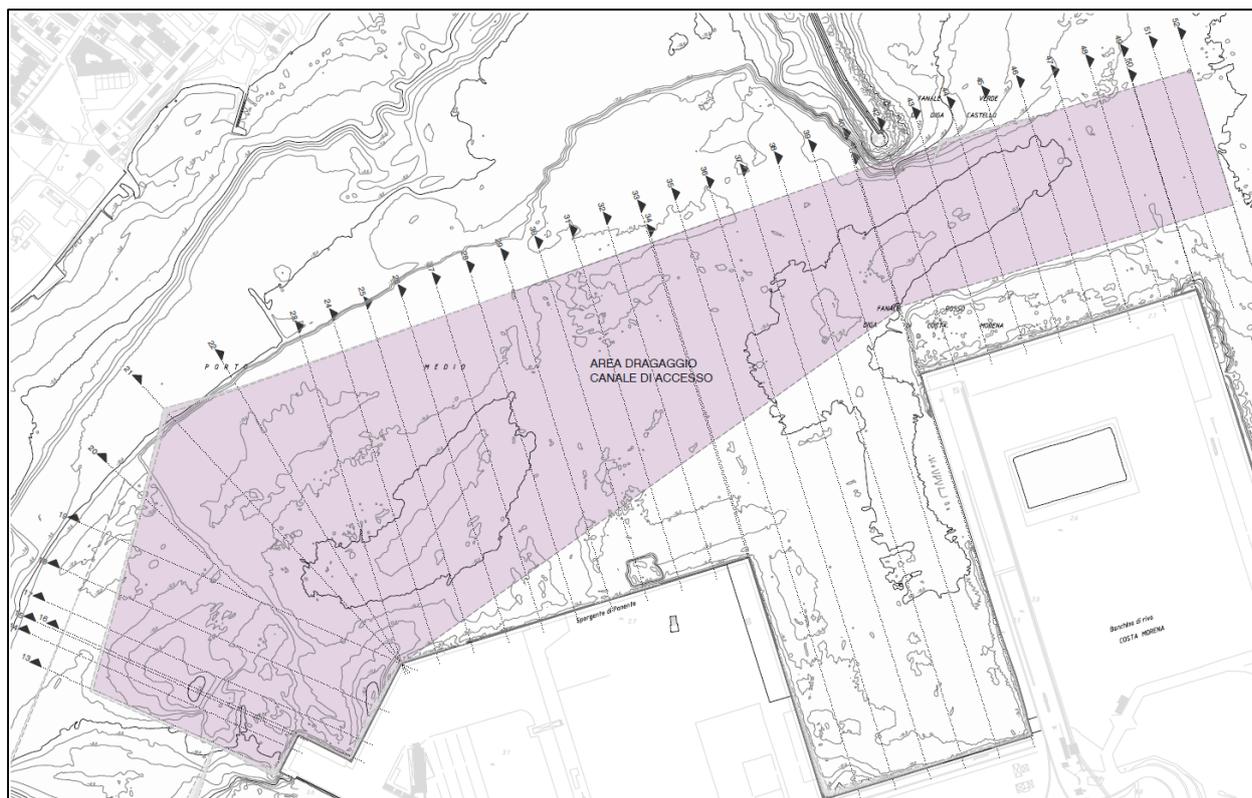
Planimetria di dragaggio Canale di accesso al porto
